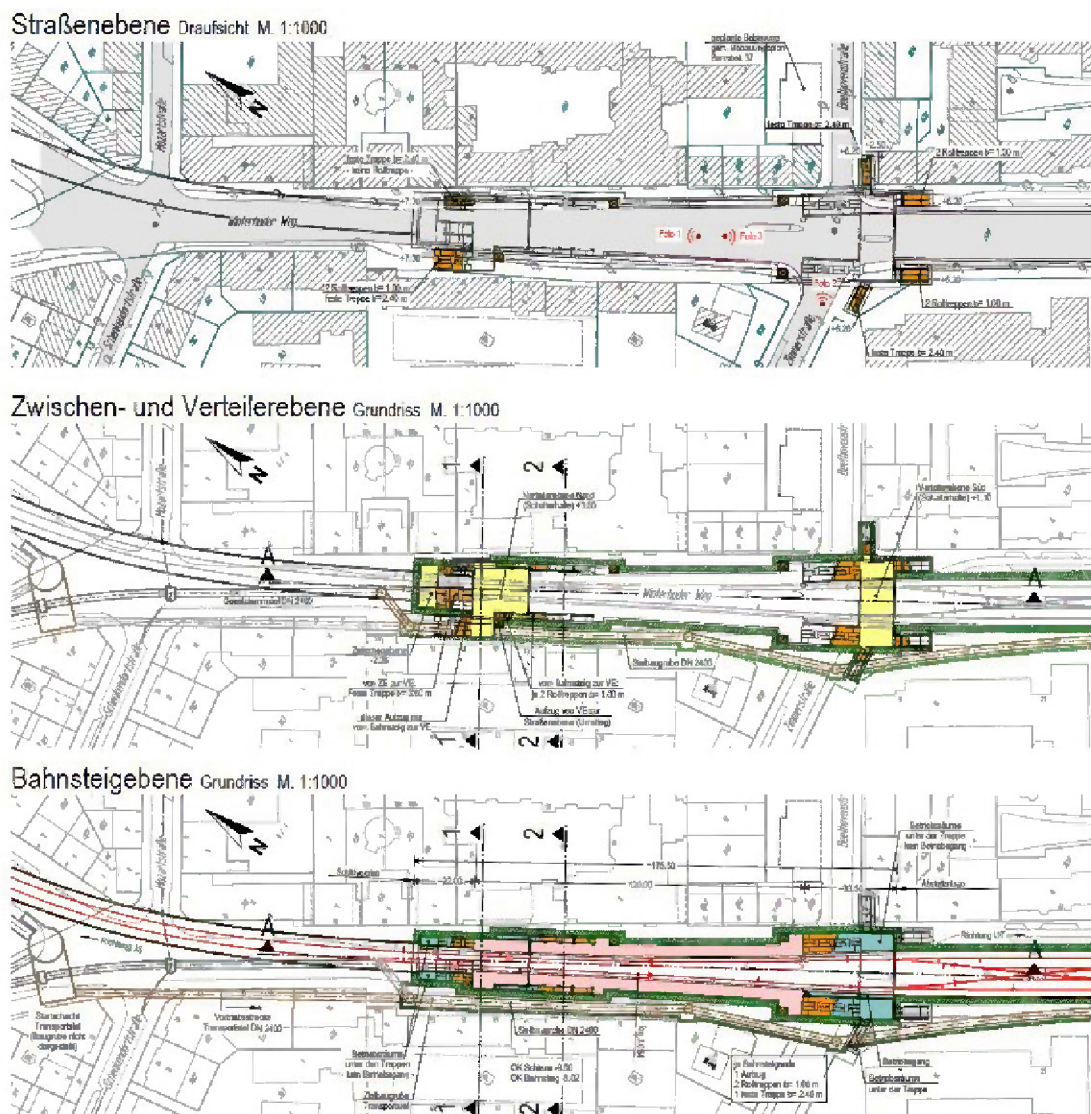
Lageplan Haltestelle Beethovenstraße
